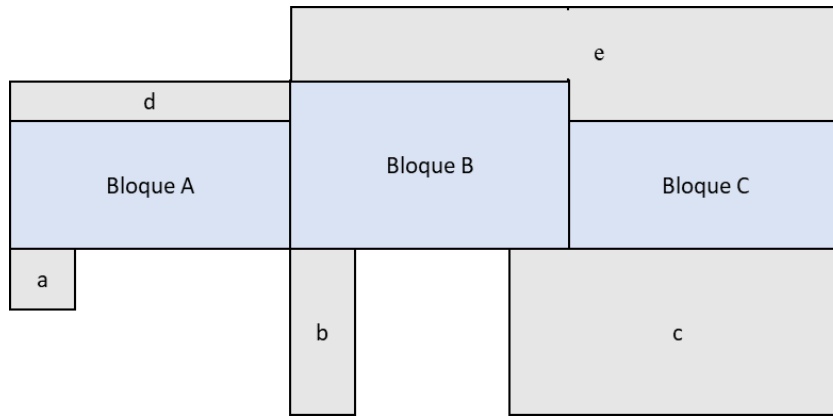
Esquema en planta de las estructuras adyacentes a los pabellones (A, B y C)
